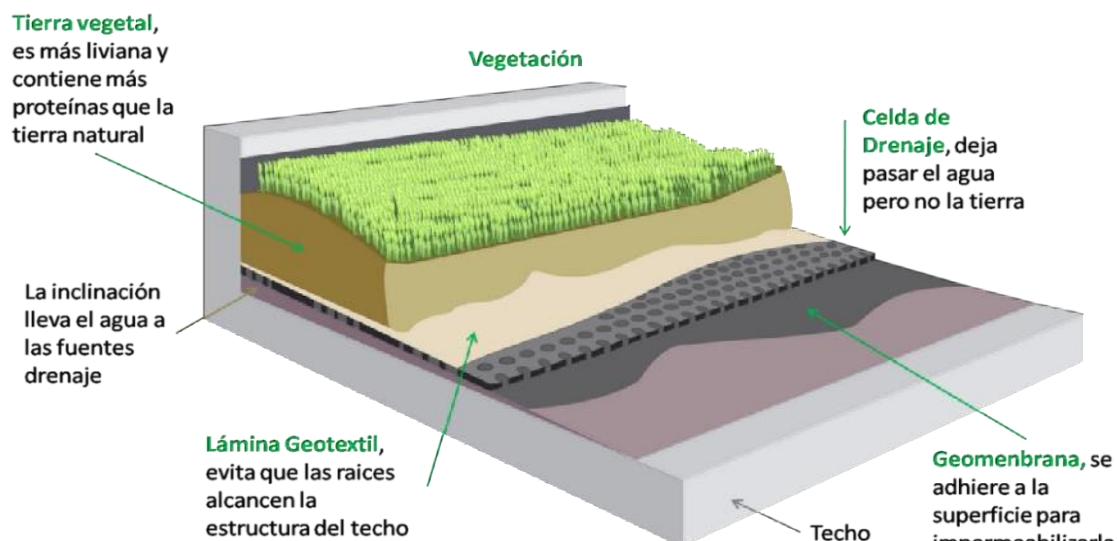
Materiales utilizados para la construcción de un techo verde. Fuente: <http://www.arqhys.com/paisajismo-con-techos-y-paredes-verdes.html>
